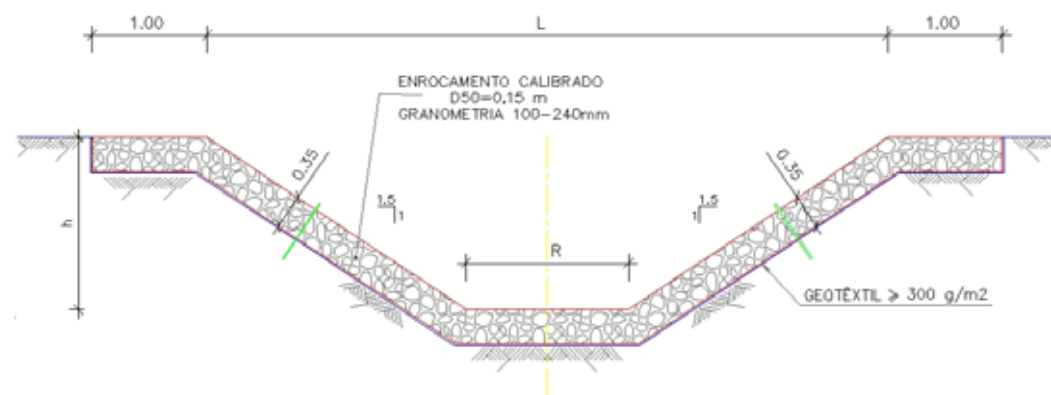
Planta e perfil transversal tipo de passagem de vau prevista construir.
